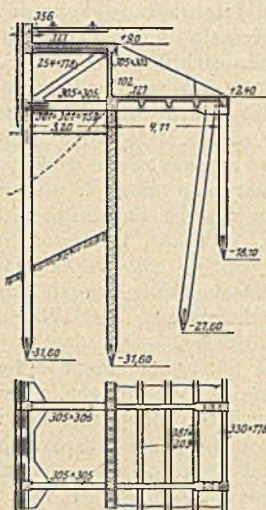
Eisenbetonspundwand und Kaimauer im Hafen von Lowestoft. Querschnitt und Grundriß.
